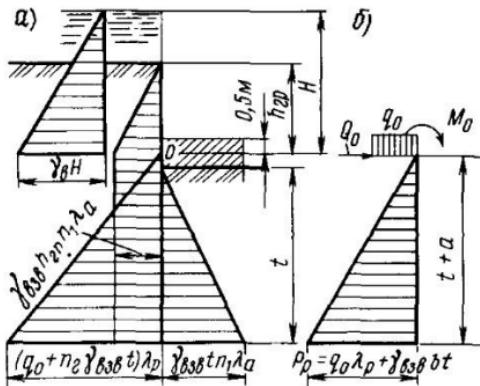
Схема для расчета свободно стоящей стенки в несвязных грунтах с подводной тампонажной подушкой: а—эпюра нагрузки для ограждения на открытом водотоке; б—расчетная схема с приведением нагрузок к силам
